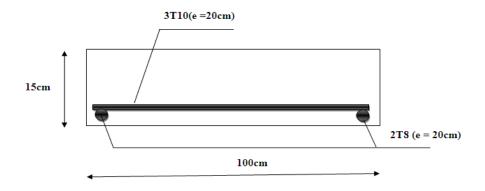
Schéma de ferraillage de l'escalier en appuis.
